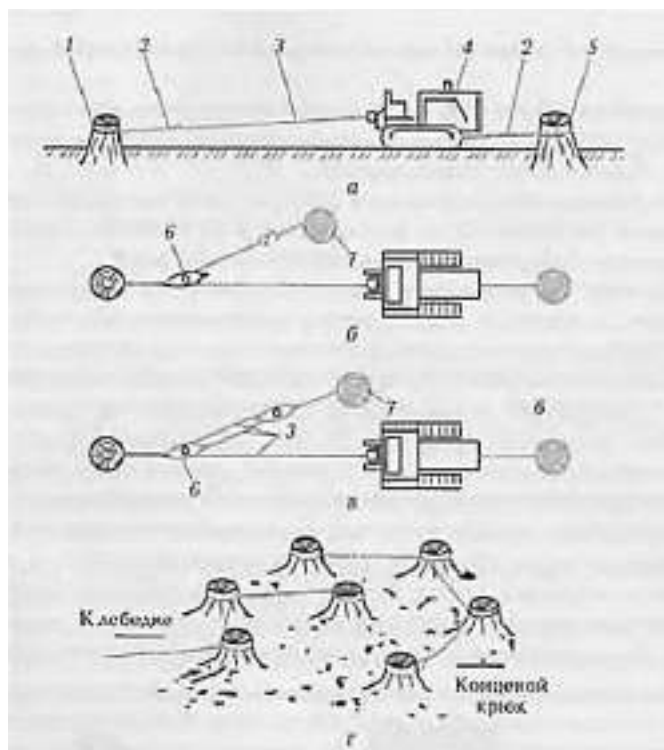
Корчевка пней тракторной трелевочно-корчевальной лебедкой: а — корчевка прямой тягой; б — корчевка при помощи двойного полиспаста; в — корчевка при помощи тройного полиспаста; г — схема групповой запасовки каната петлеванием за несколько корчуемых пней; 7 — корчуемый пень; 2 — анкерный канат; 3 — тяговый канат; 4 — трактор с лебедкой; 5 — анкерный пень; 6 — блок; 7 — вспомогательный анкерный пень.
